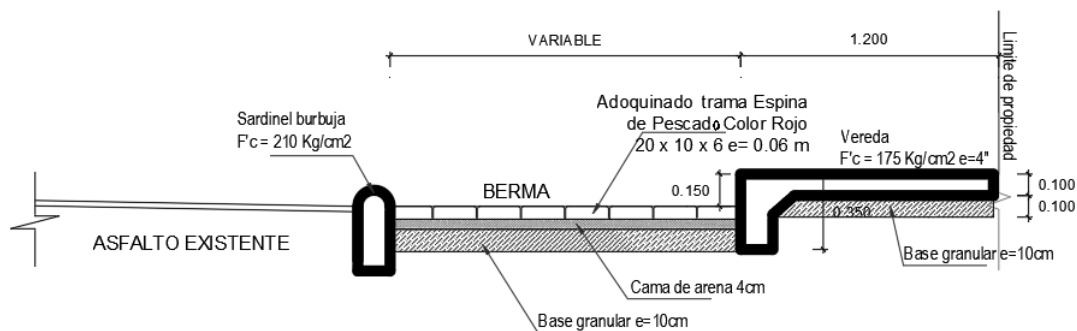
Vista de corte de la berma de la calle José Balta
